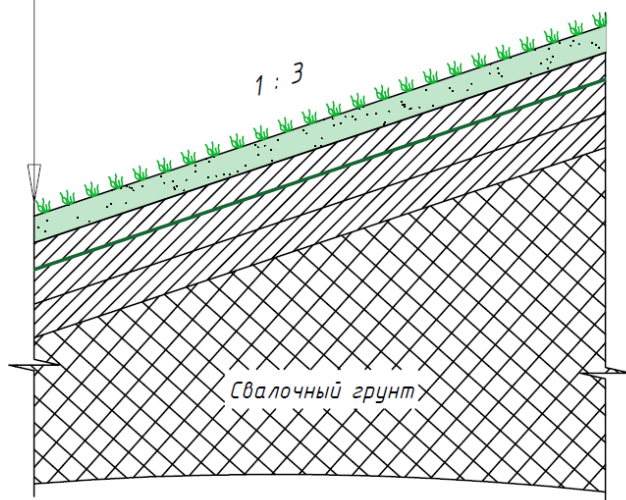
Конструкция верхнего изолирующего покрытия
